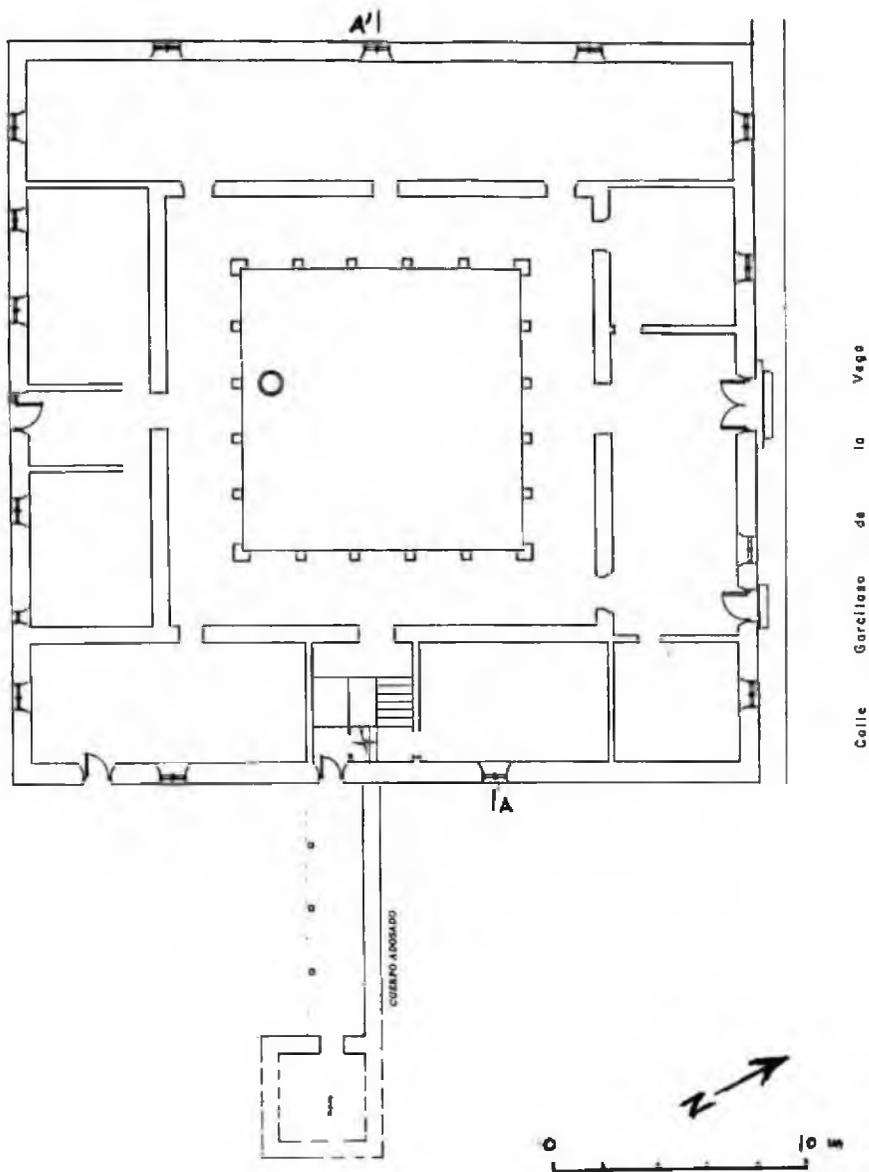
Plano de planta a escala 1:200 (según Moraleda Bravo).
